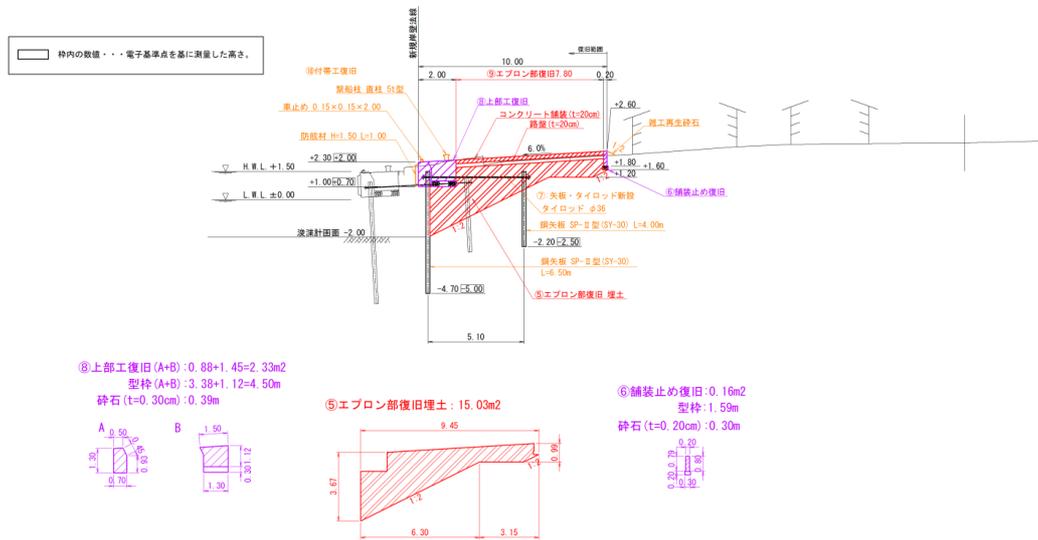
No.15 日立港区_第5埠頭地区第2船だまりの東2断面図(復旧後)
